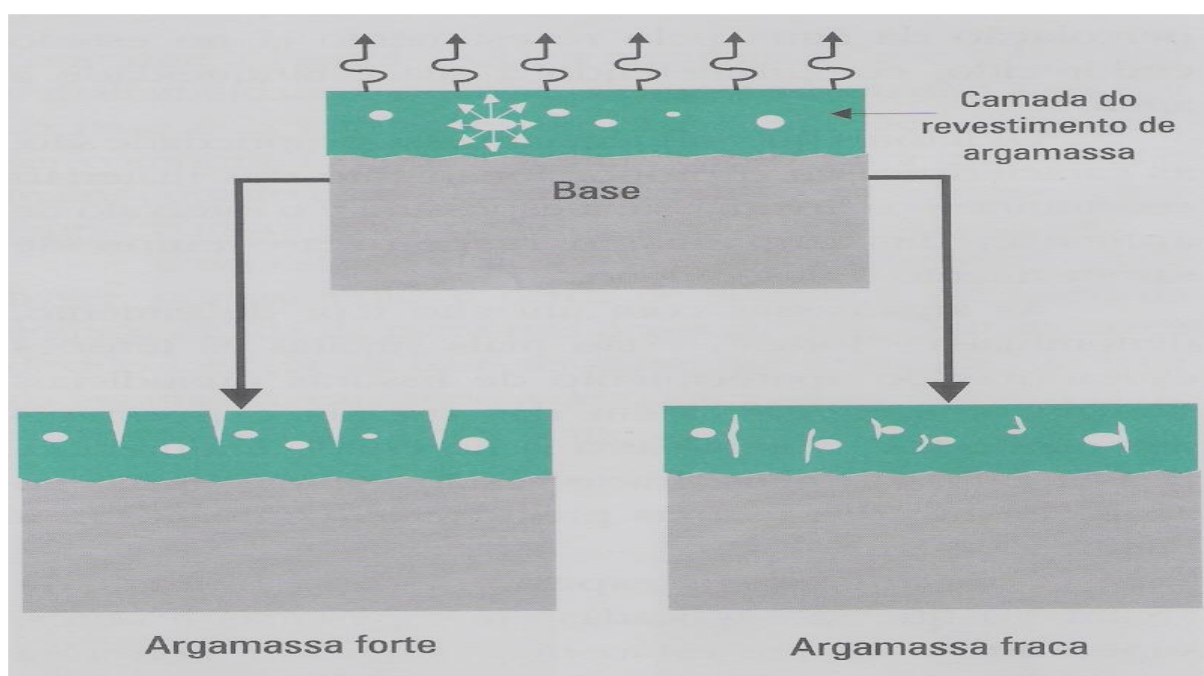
Fissuração da argamassa por retração na secagem: argamassa forte x argamassa fraca. Fonte: (BAÍA; SABBATINI, 2000)
